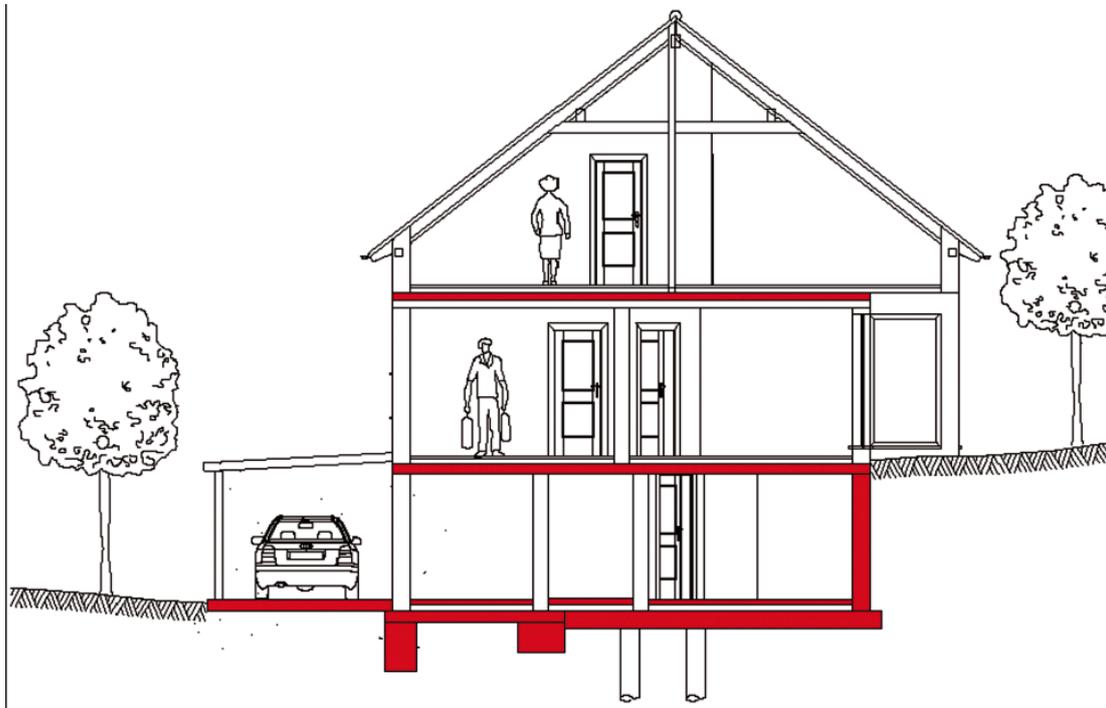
TAB-House™ fasst die Bauteile im Einfamilienhausbereich zusammen. Die Bemessung von Fundamentplatten und (Keller-)Wänden erfolgt nach Faserbetonklassen. Als zusätzliche Sicherheit steht bei Arcelor Wire Drawing jeweils eine Bauteilzulassung des Instituts für Bautechnik in Berlin zur Verfügung. Die Erfüllung der hohen Anforderungen des DIBT zur Erlangung dieser Zulassungen zeigt, auf welchem Niveau die Anwendung von Stahlfaserbeton bereits angekommen ist.
